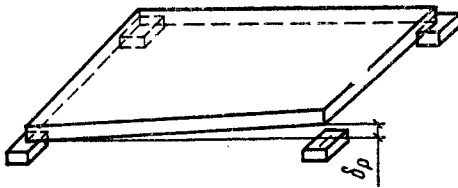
Определение неплоскостности бетонных и железобетонных изделий
